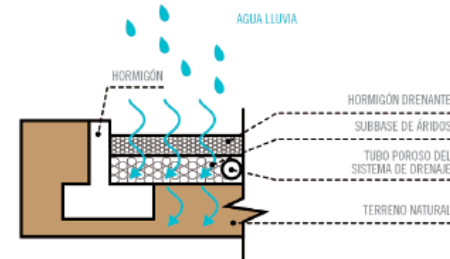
PAVIMENTO PERMEABLE CON ALMACENAMIENTO
